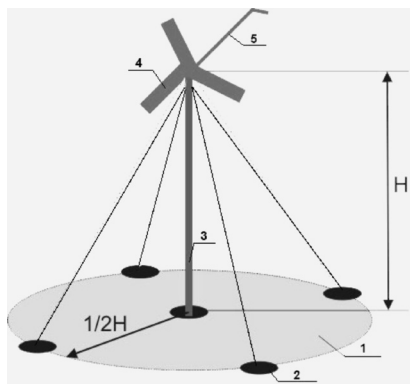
Схема монтажа и установки ВЭУ на площадке.
